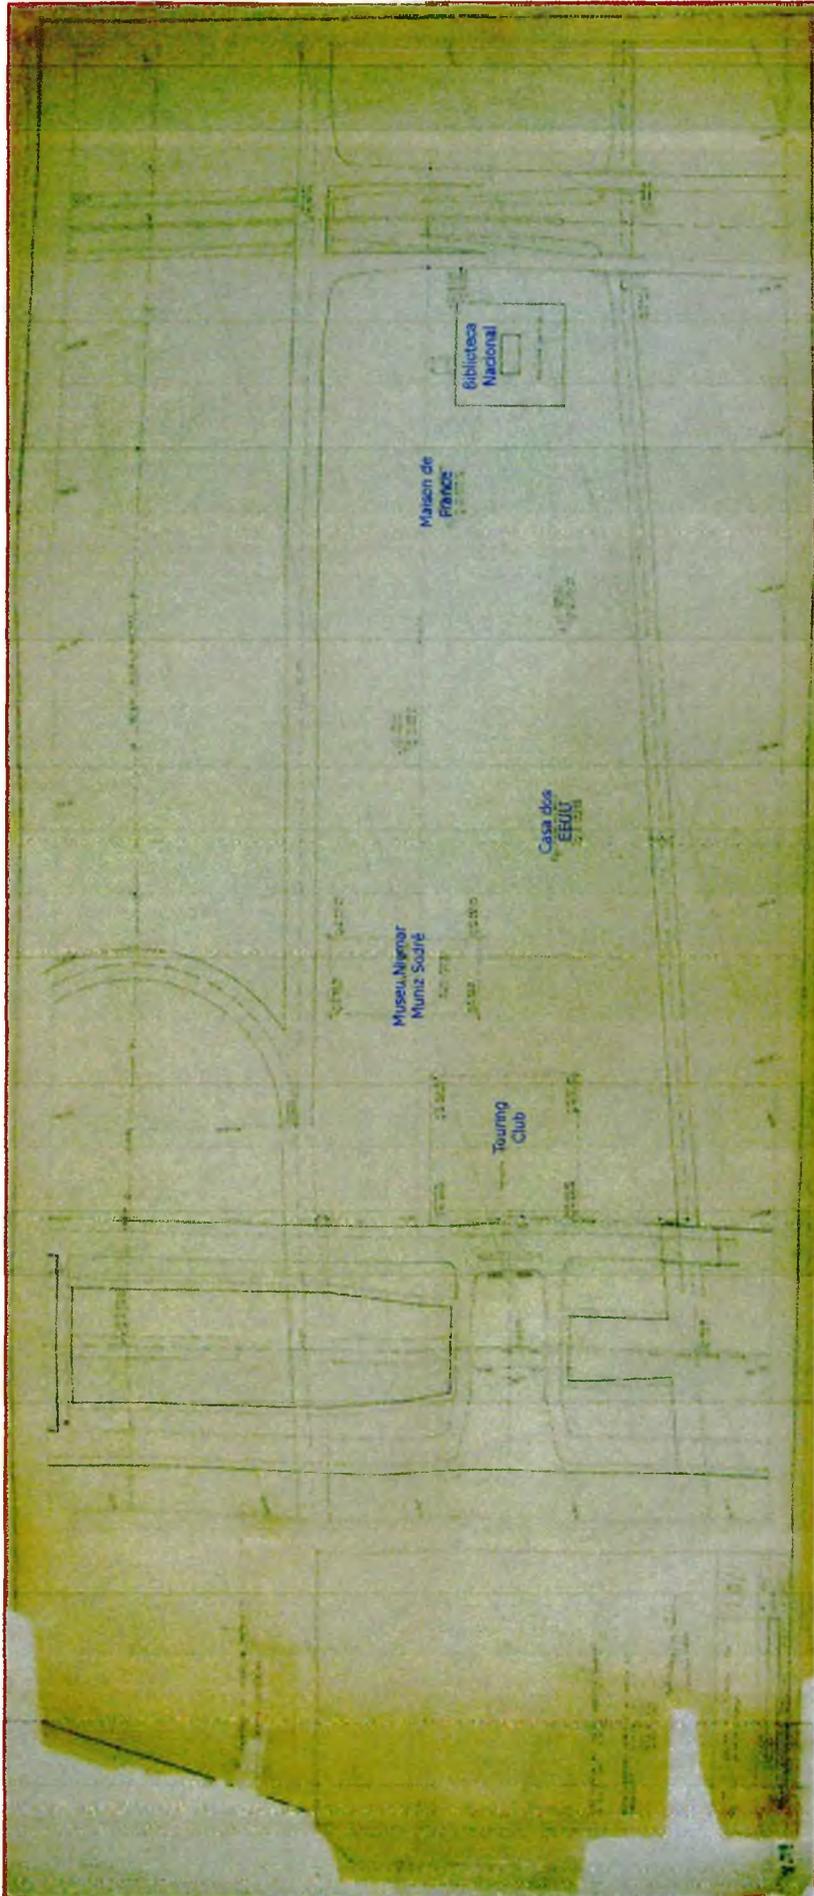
planta n. 55 - SCTS 1.0/1
